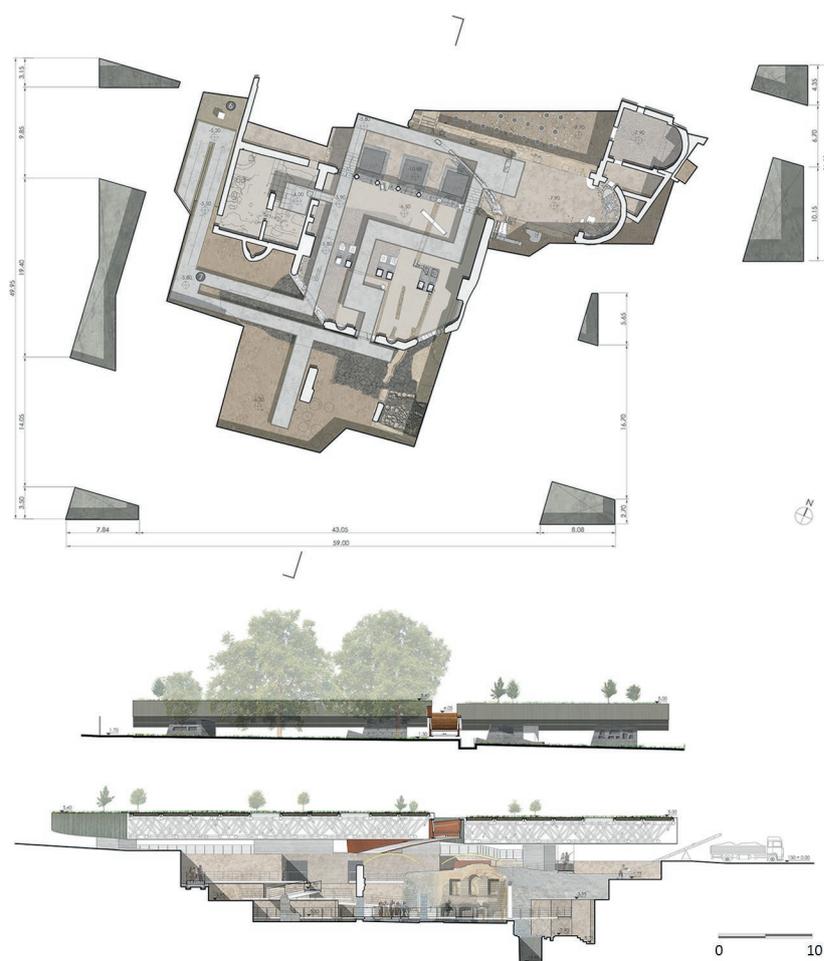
(A partire da sopra) pianta degli scavi con vista dei piloni cavi; prospetto est; sezione nord-sud.
